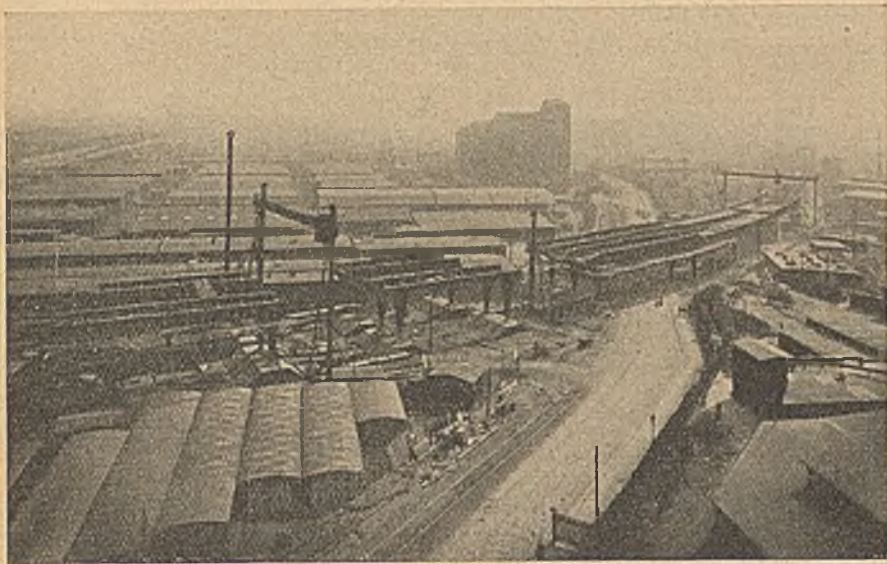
Viaduktstrecke in der Montage zwischen „Untere Spreebrücke“ und Siemensstraße. Kreuzung des Nonnendamms. Die Gleise werden vor dem Bahnhof „Wernerwerk“ auf eingleisige Brücken auseinandergezogen.
